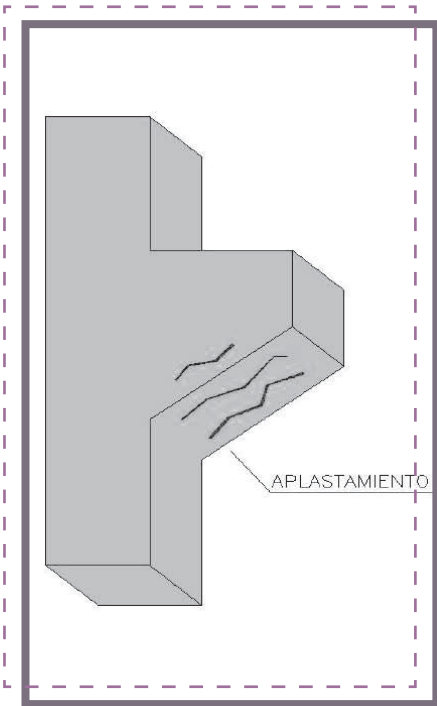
Imagen de fisuraciones por compresión en una ménsula de hormigón armado.
